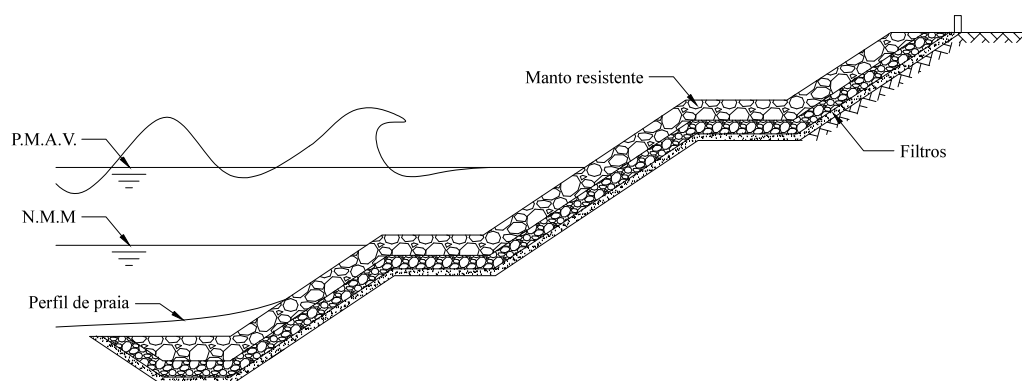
Corte transversal esquemático da obra longitudinal aderente de Cortegaça, com duas banquetas.
